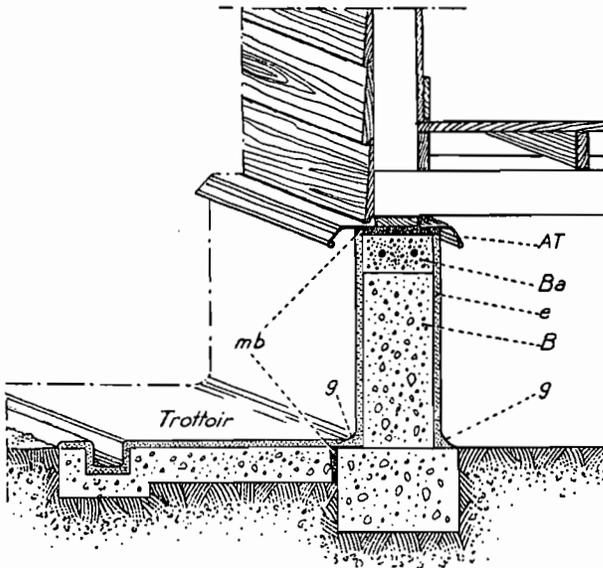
Construction en bois posée sur un soubassement en béton avec trottoir en béton coulé.
